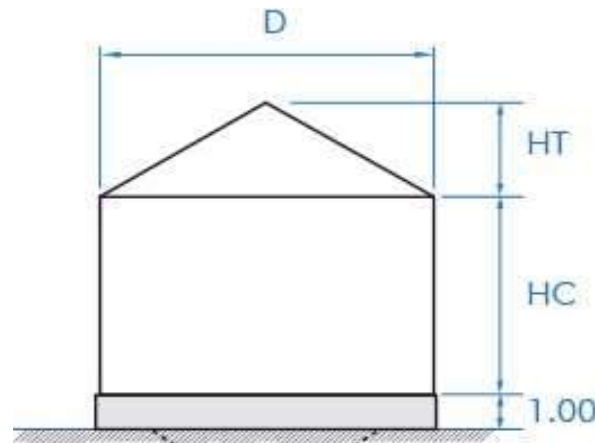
Dimensiones de un silo de fondo plano – Sansoni S.A.
